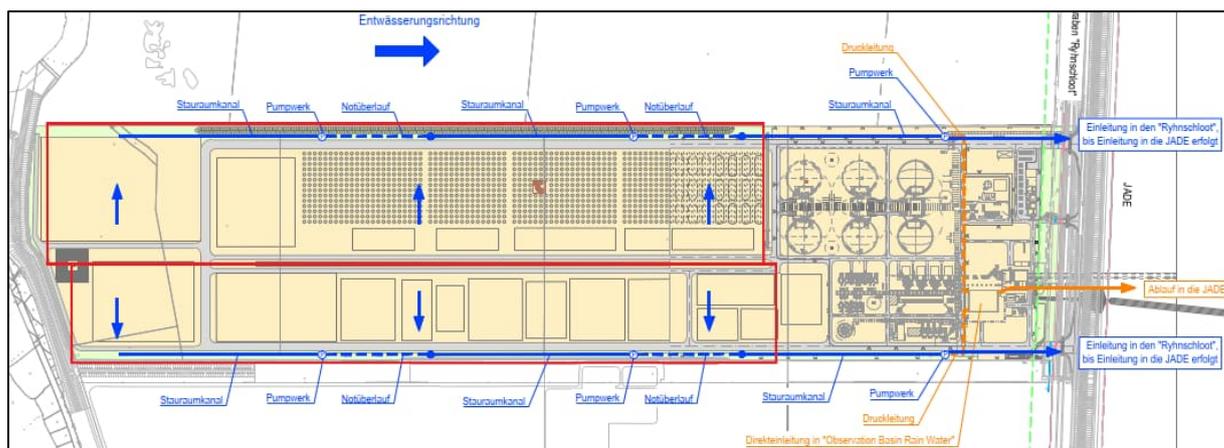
Schemaskizze der geplanten Entwässerung im Plangebiet B-Plan 225
